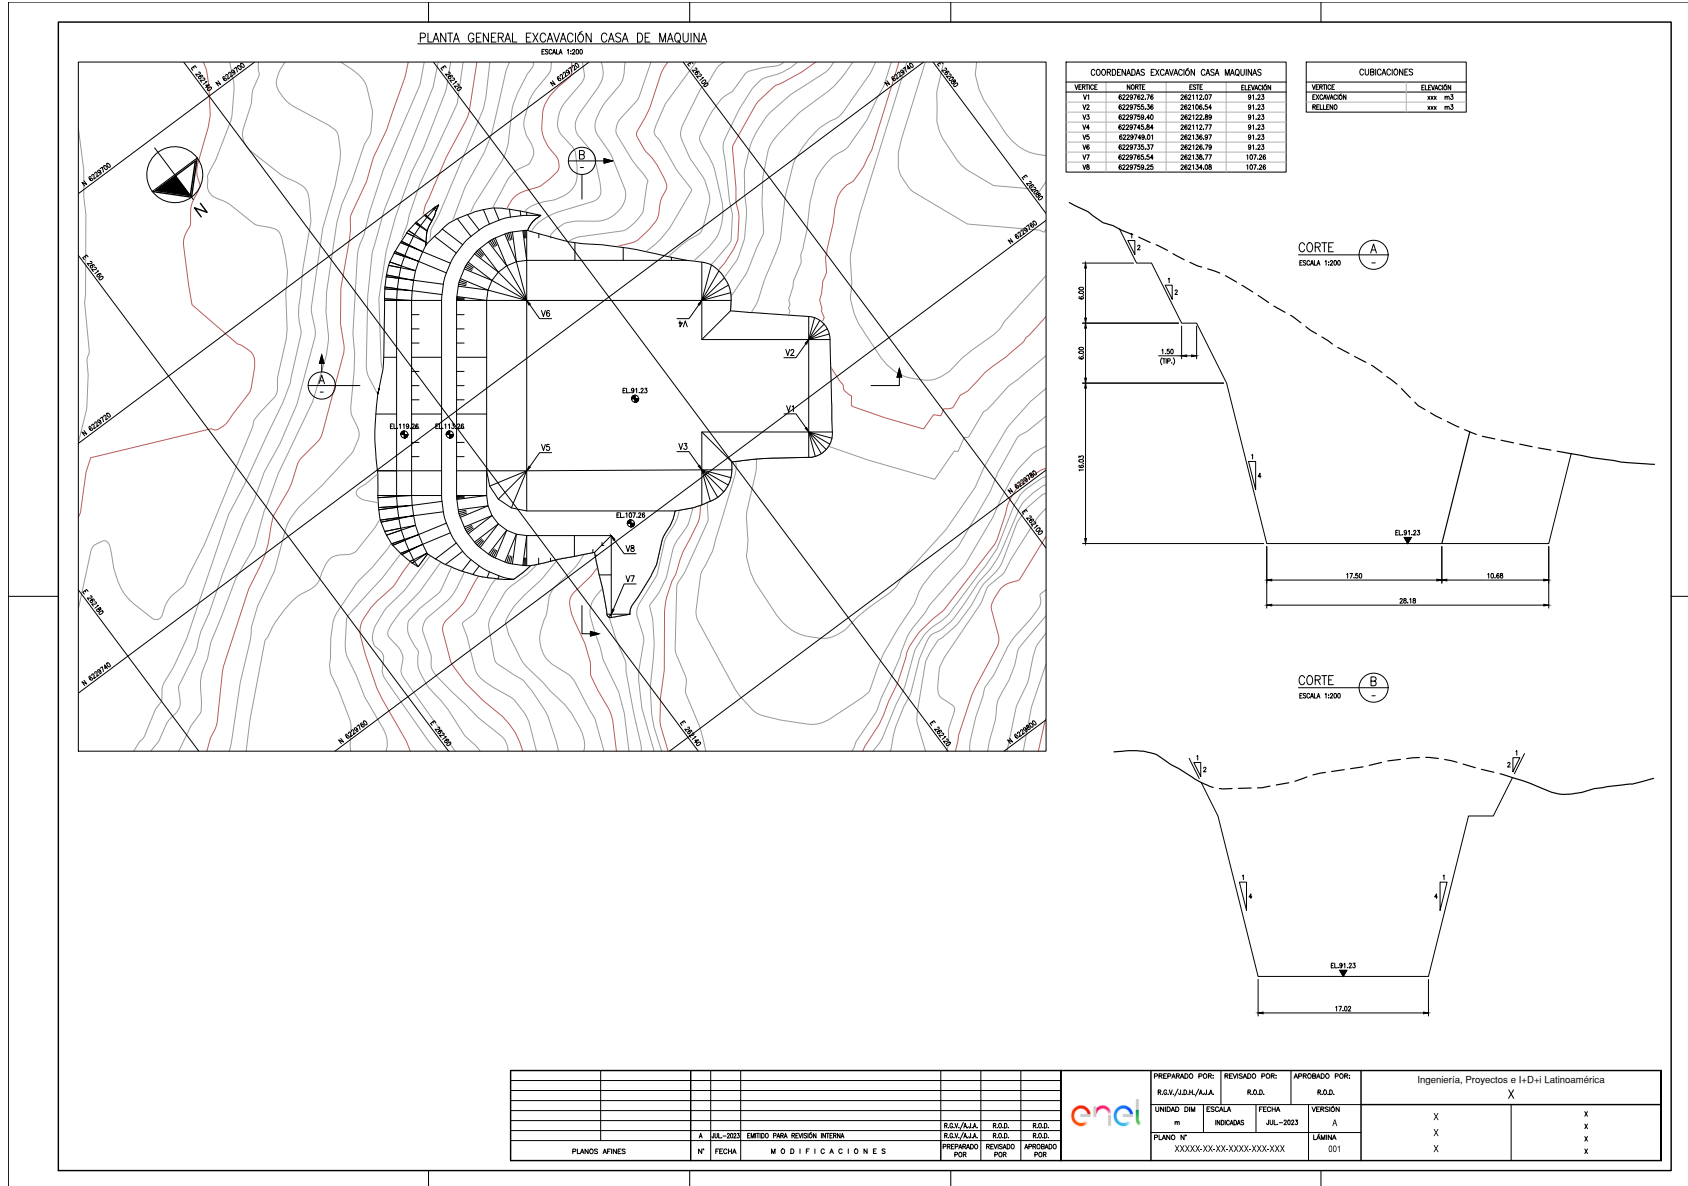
Planta general excavación casa de máquinas. Fuente: Guzmán Vargas, R.
